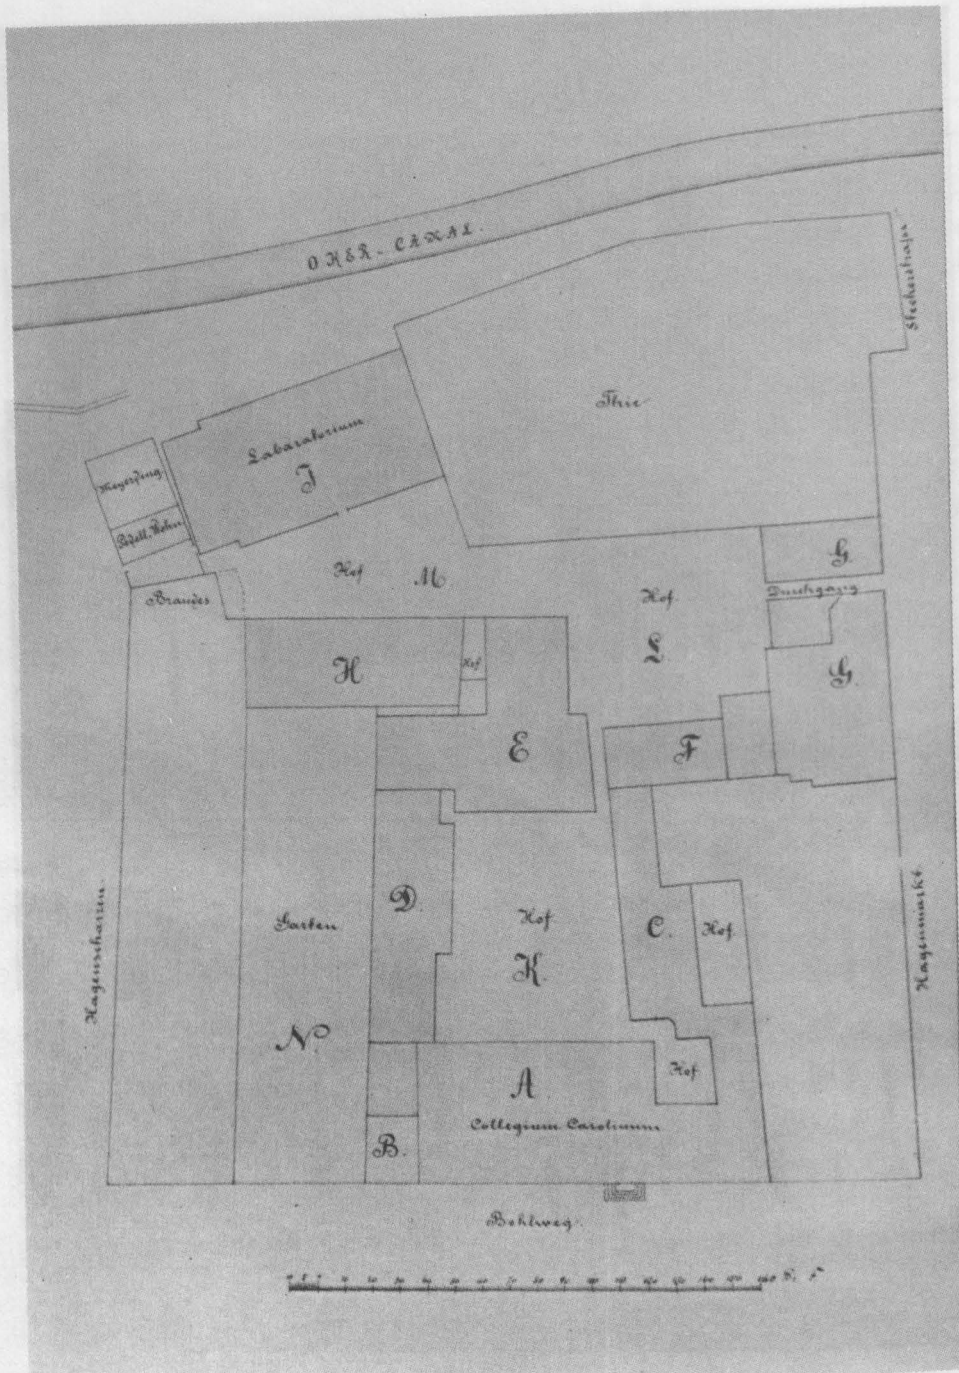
Lageplan der Collegiumsbauten. Der Buchstabe B bezeichnet das Lesezimmer der Bibliothek.
